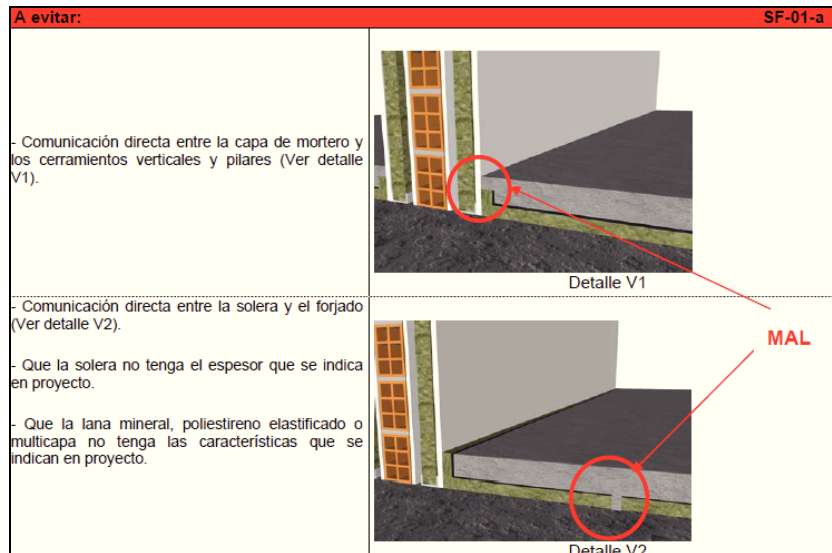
parte di una scheda, estratta dalle Linee Guida spagnole [16], relativa a due errori da evitare nella posa del pavimento galleggiante
